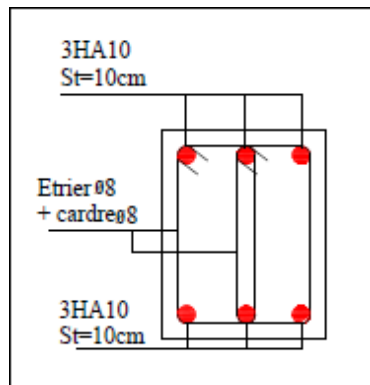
Schéma de ferrailage de la poutre de chaînage.
